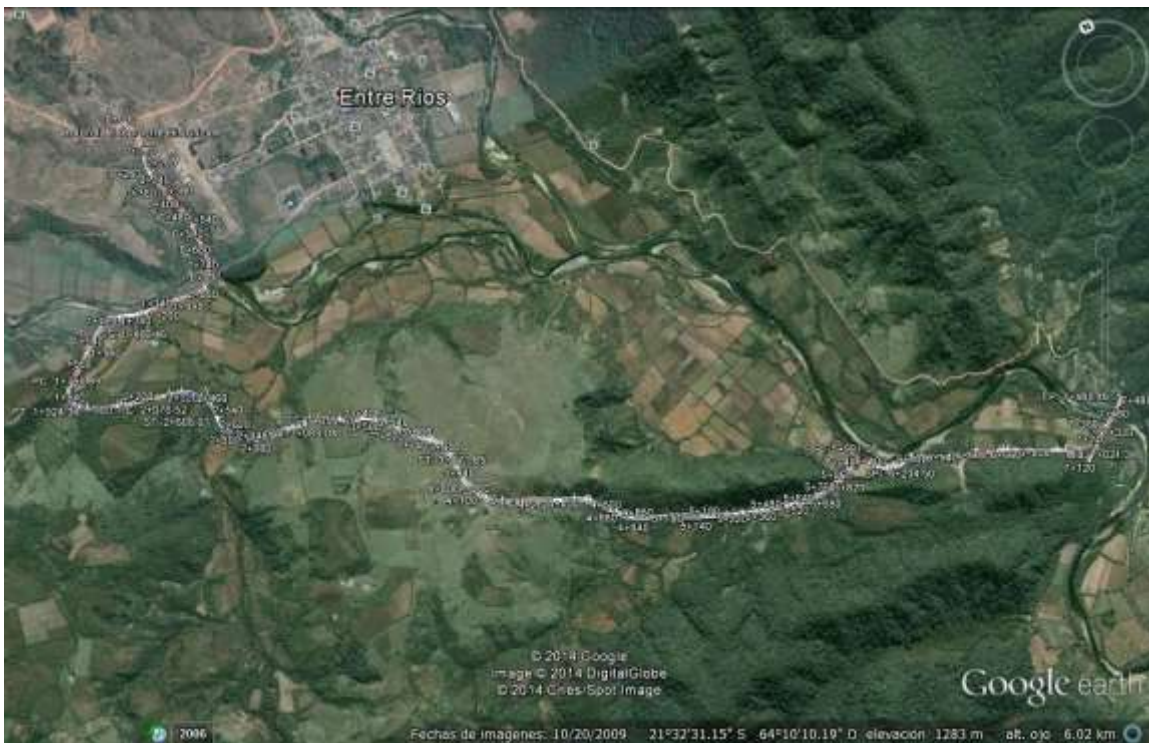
Planteamiento y trazo vial Alternativa III (Fuente: Imagen Google Earth;
